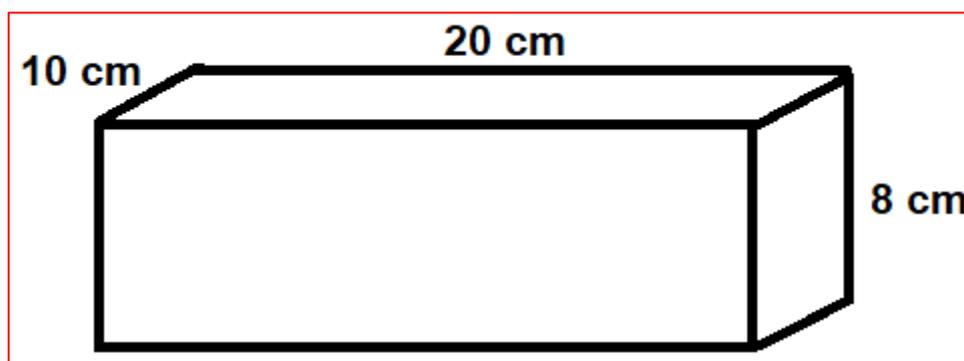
Dimensionamiento del adoquín de concreto requerido para la avenida Paraíso.
